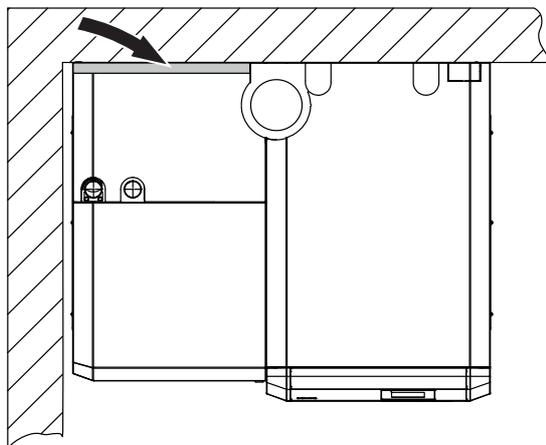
Caldaia a sinistra e sul retro a filo muro – vista dall'alto
